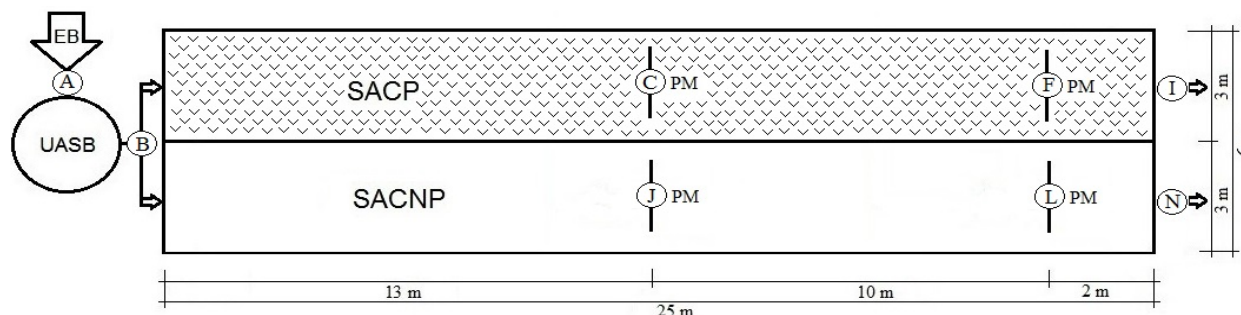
Vista em planta do Sistema Alagado Construído, com dimensões e localização de pontos de monitoramento. Observação: desenho fora de escala. Legenda: EB=Esgoto Bruto; UASB=Upflow Anaerobic Sludge Blanket; SACP=Sistema Alagado Construído Plantado; SACNP=Sistema Alagado Construído Não Plantado; PM=Poço de Monitoramento.
